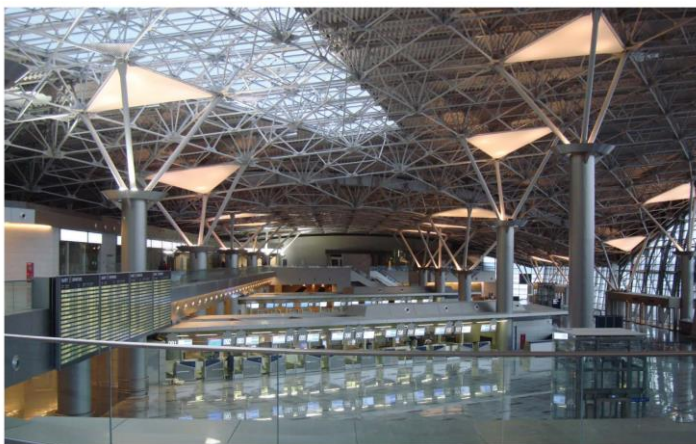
Опираие двухпоясной сетчатой оболочки на железобетонные колонны
